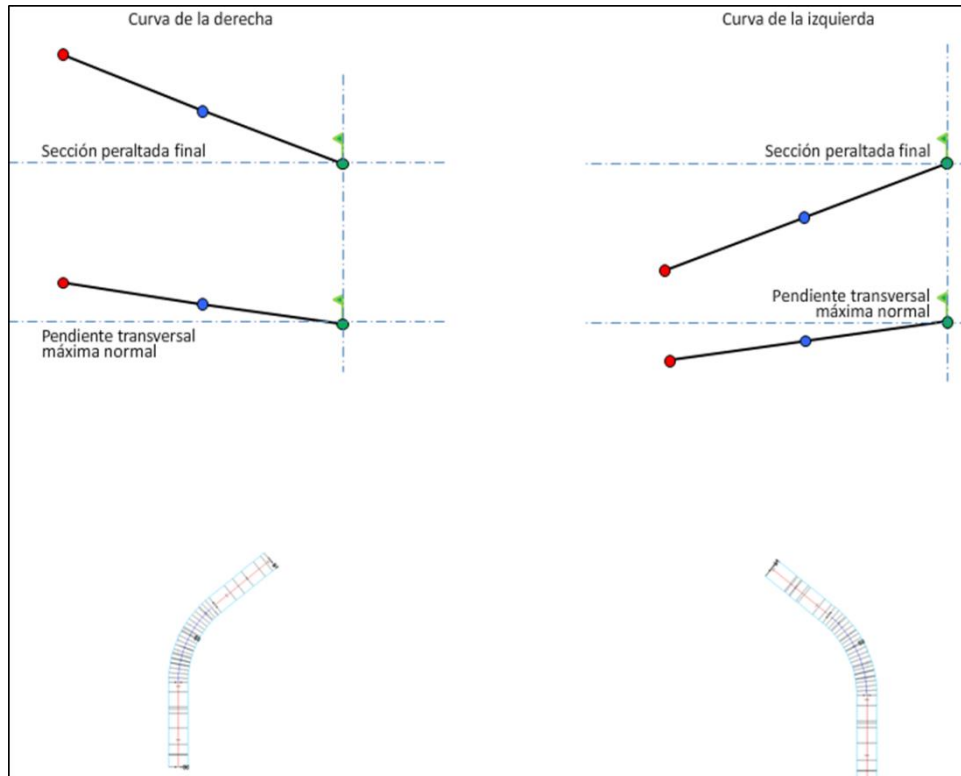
136 Peralte calzada con sección transversal punto giro lado derecho
